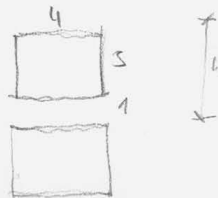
Grundriss mit eigenen Notizen zum Maßstab und zu den geschätzten Raumhöhen, Skizze zu Rekonstruktion der Perspektive
